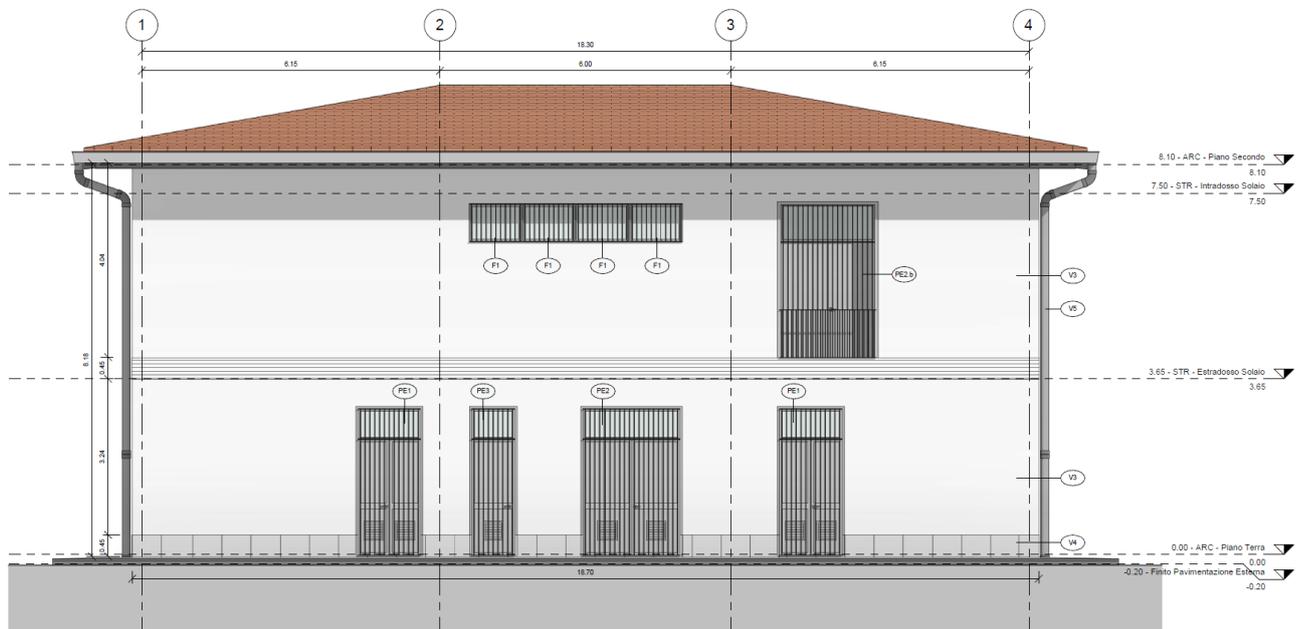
PPM Pieve Emanuele – Prospetto Nord-Ovest (Lato Binari)
